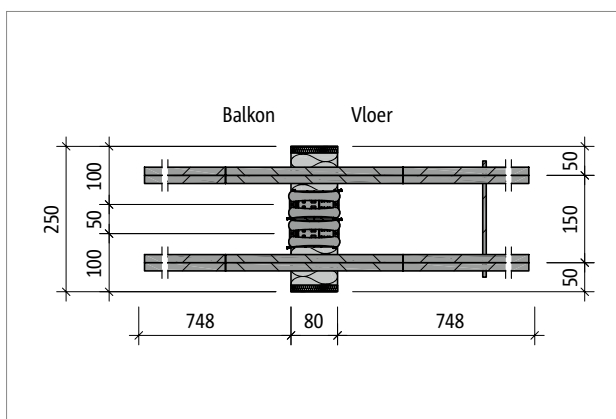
Schöck Isokorf® type Q-E-W-VV5: Bovenaanzicht
